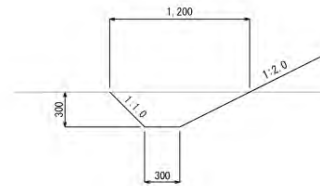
Coupe transversale typique de la voie de déviation
